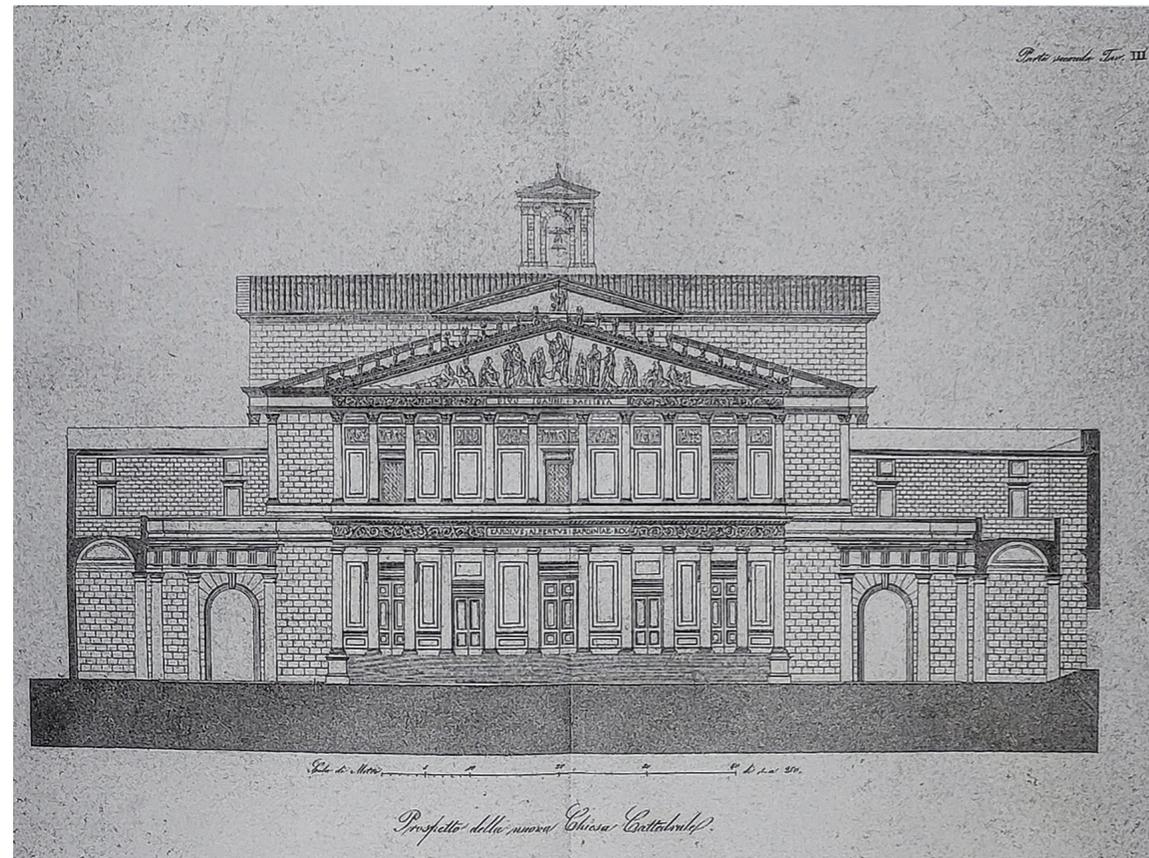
Prospetto della Nuova Chiesa Cattedrale di Luigi Canina
